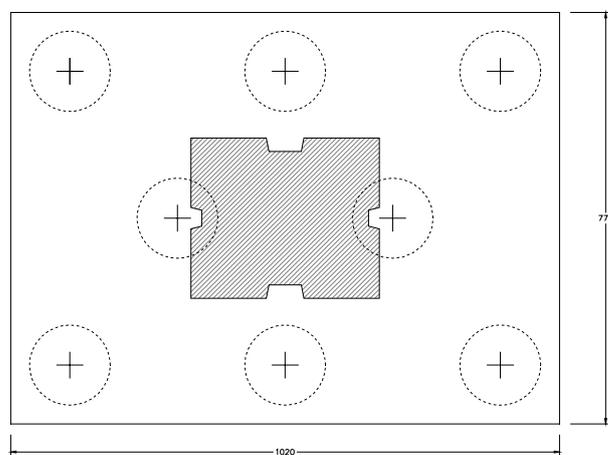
fondazione Pila (P2-P3 carreggiata SX)
